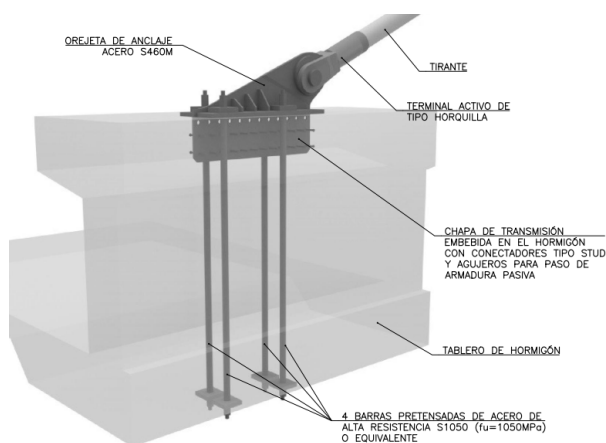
Esquema de sistema de anclaje al tablero de orejeta inferior de tirante.
